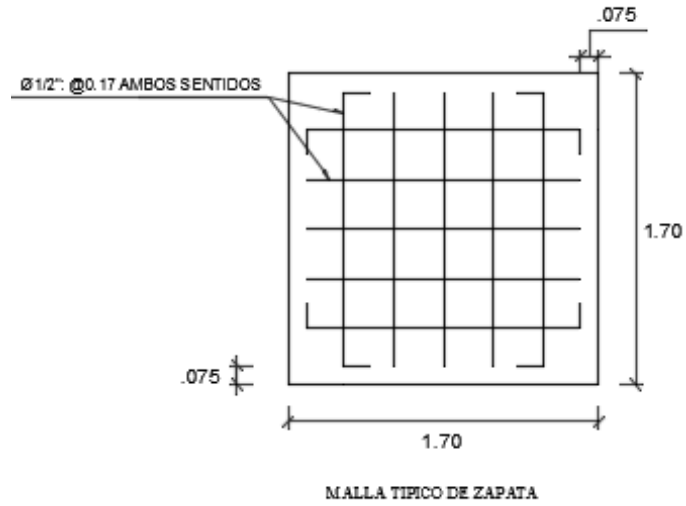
Zapatas aisladas en sistema estructural empleando losas aligeradas convencionales. Elaboración propia.
